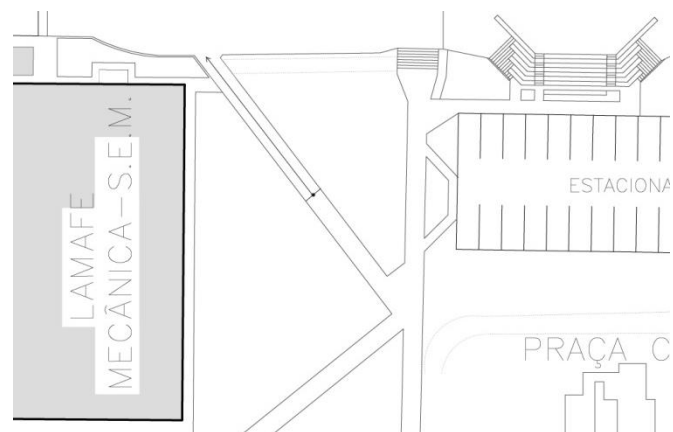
Planta da rampa de acesso. Fonte: Juliana Barberio.
